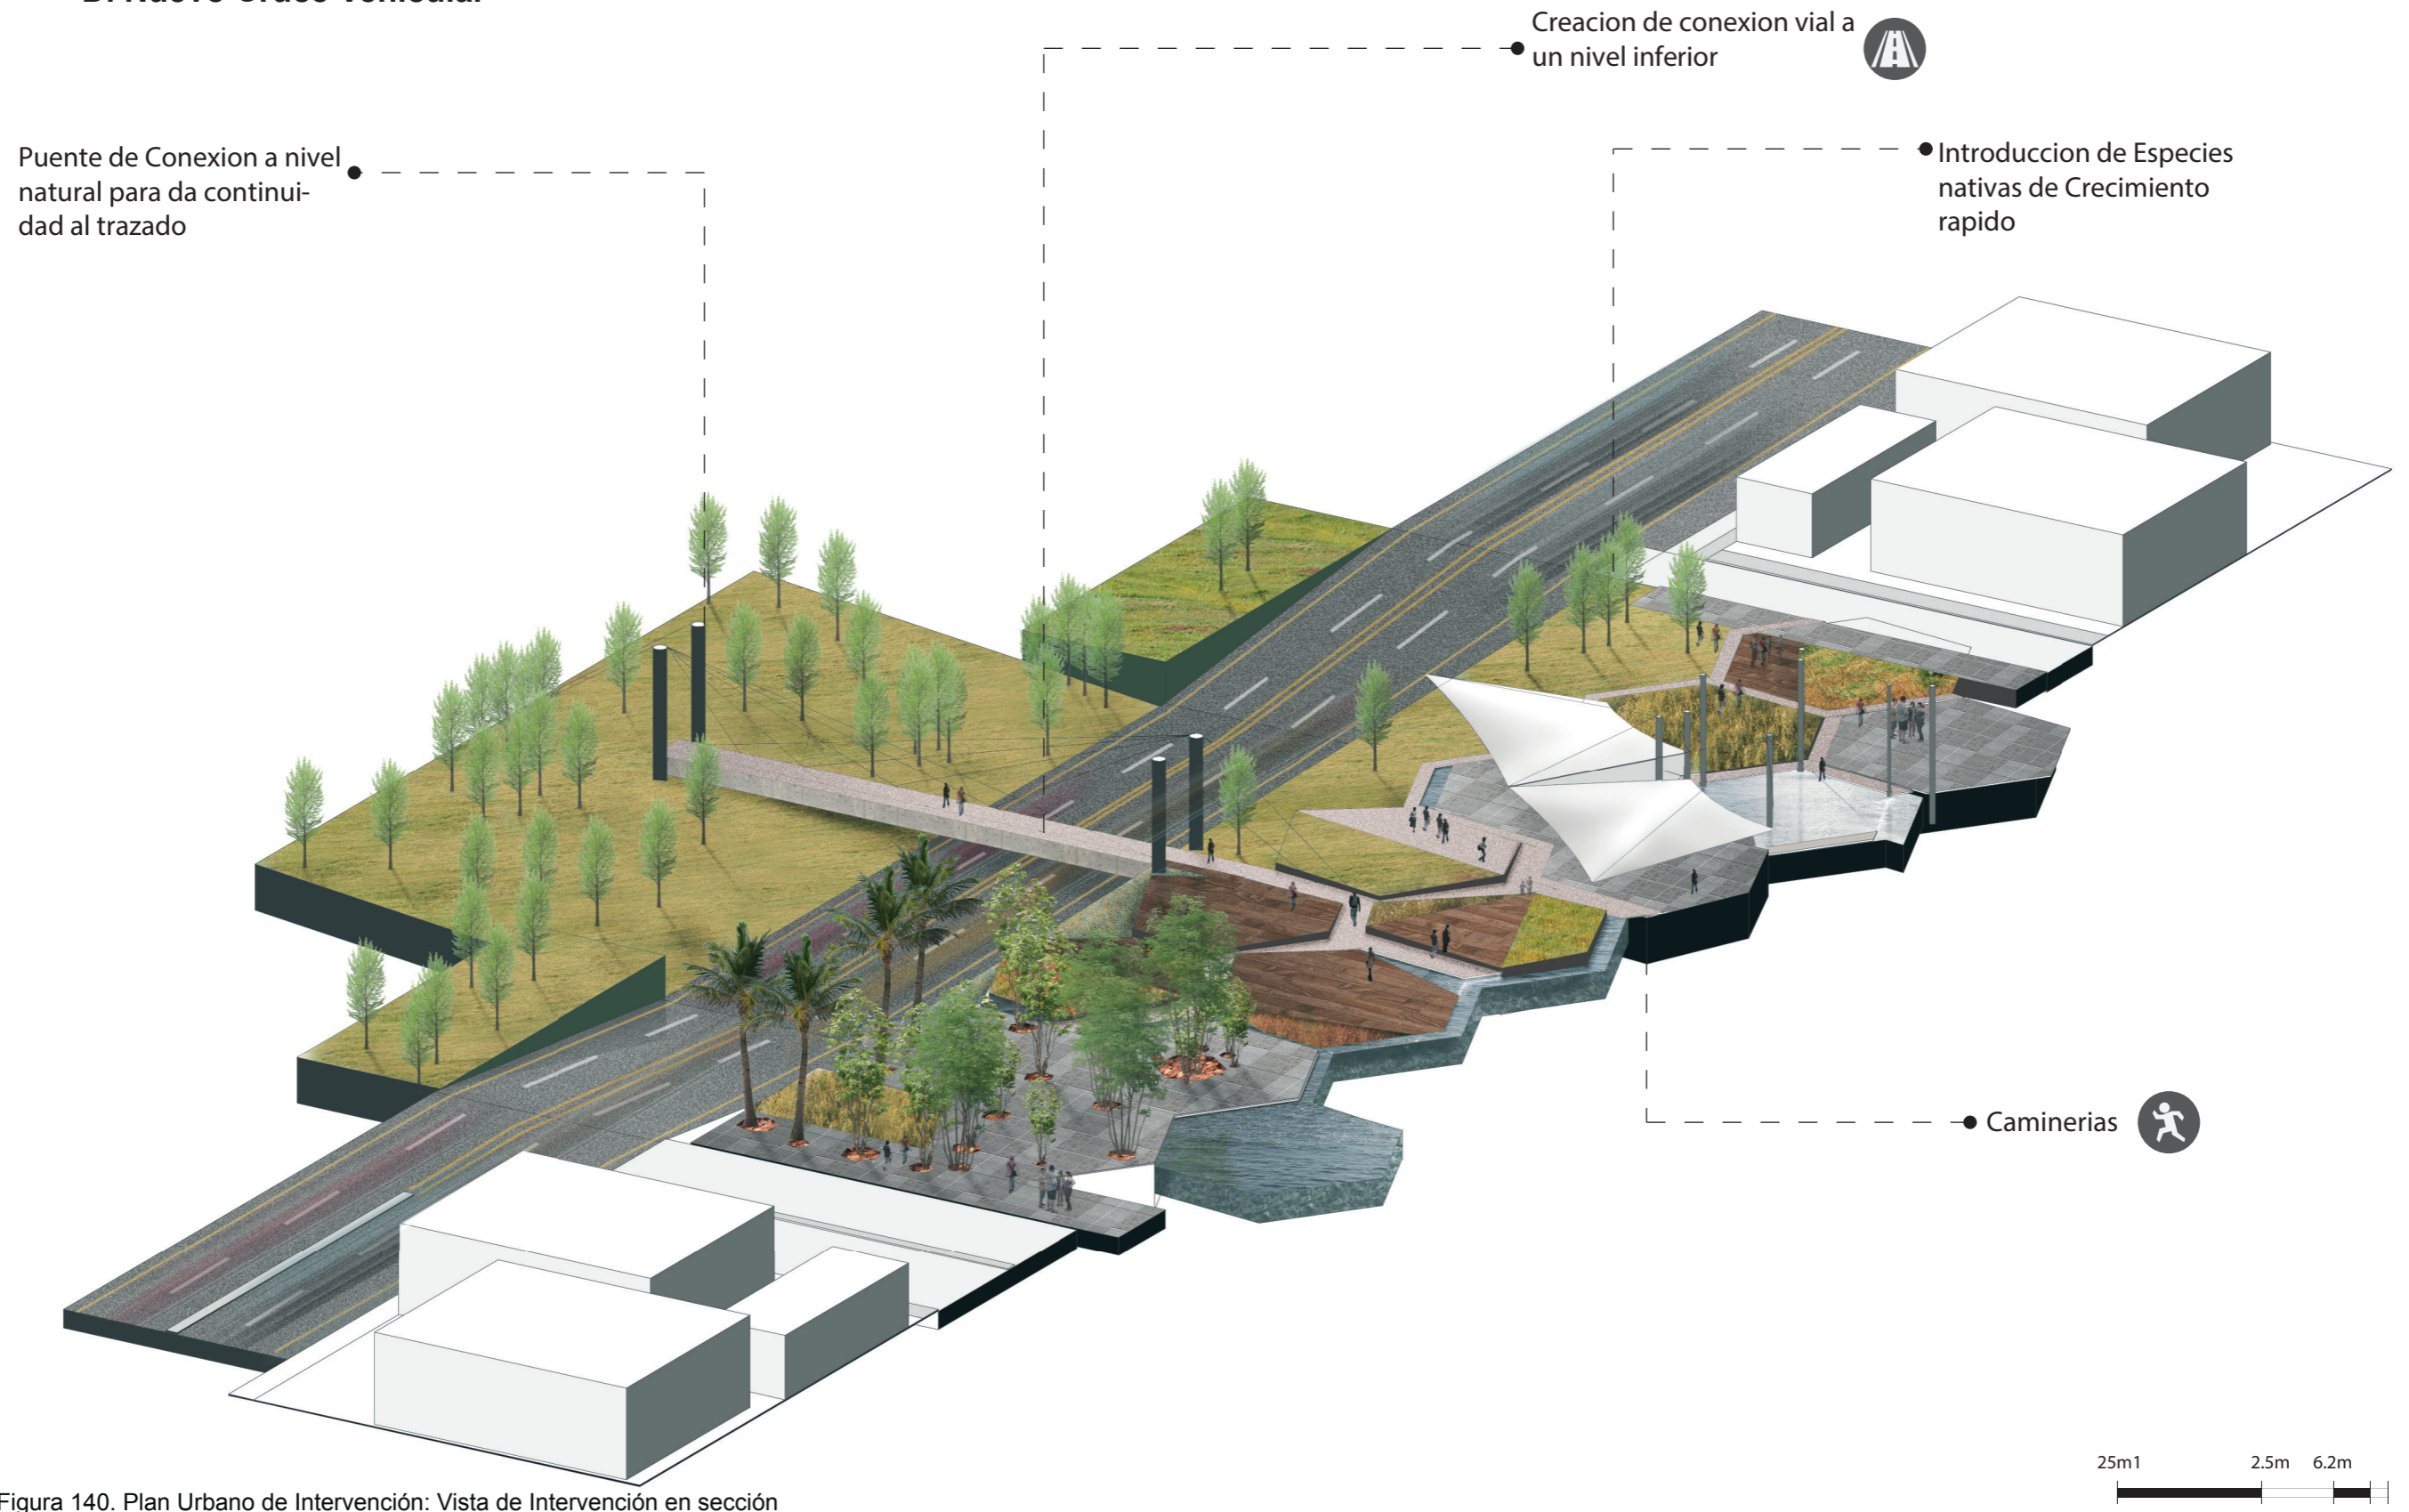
Plan Urbano de Intervención: Vista de Intervención en sección
